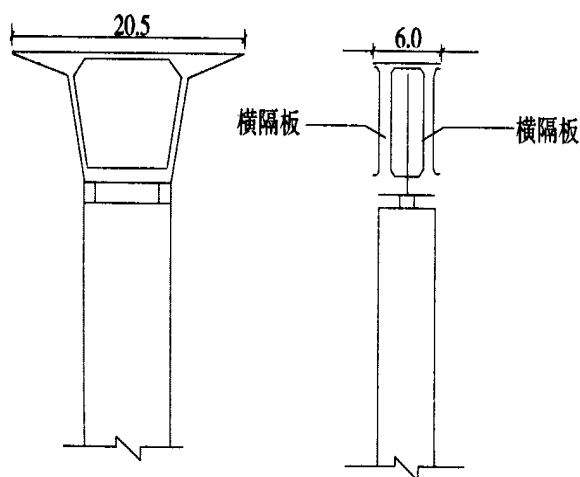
主跨 98 m 连续箱梁 0[#]断面示意 单位: m
